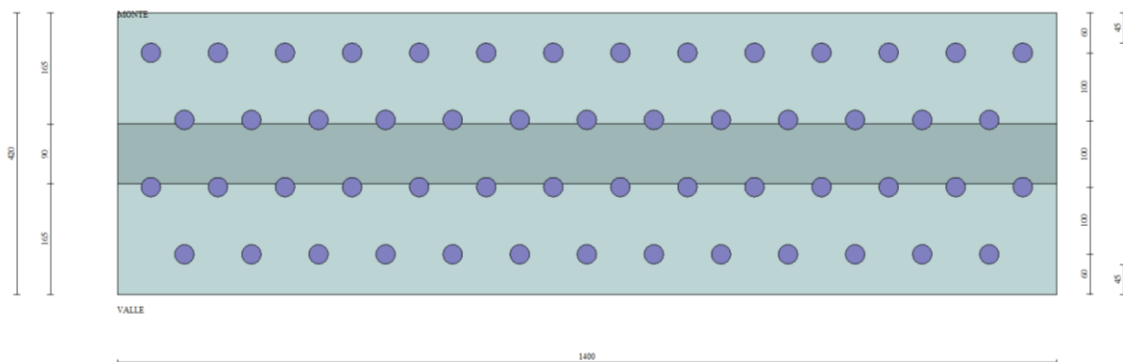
Muro Tipo C: disposizione dei micropali di fondazione.
